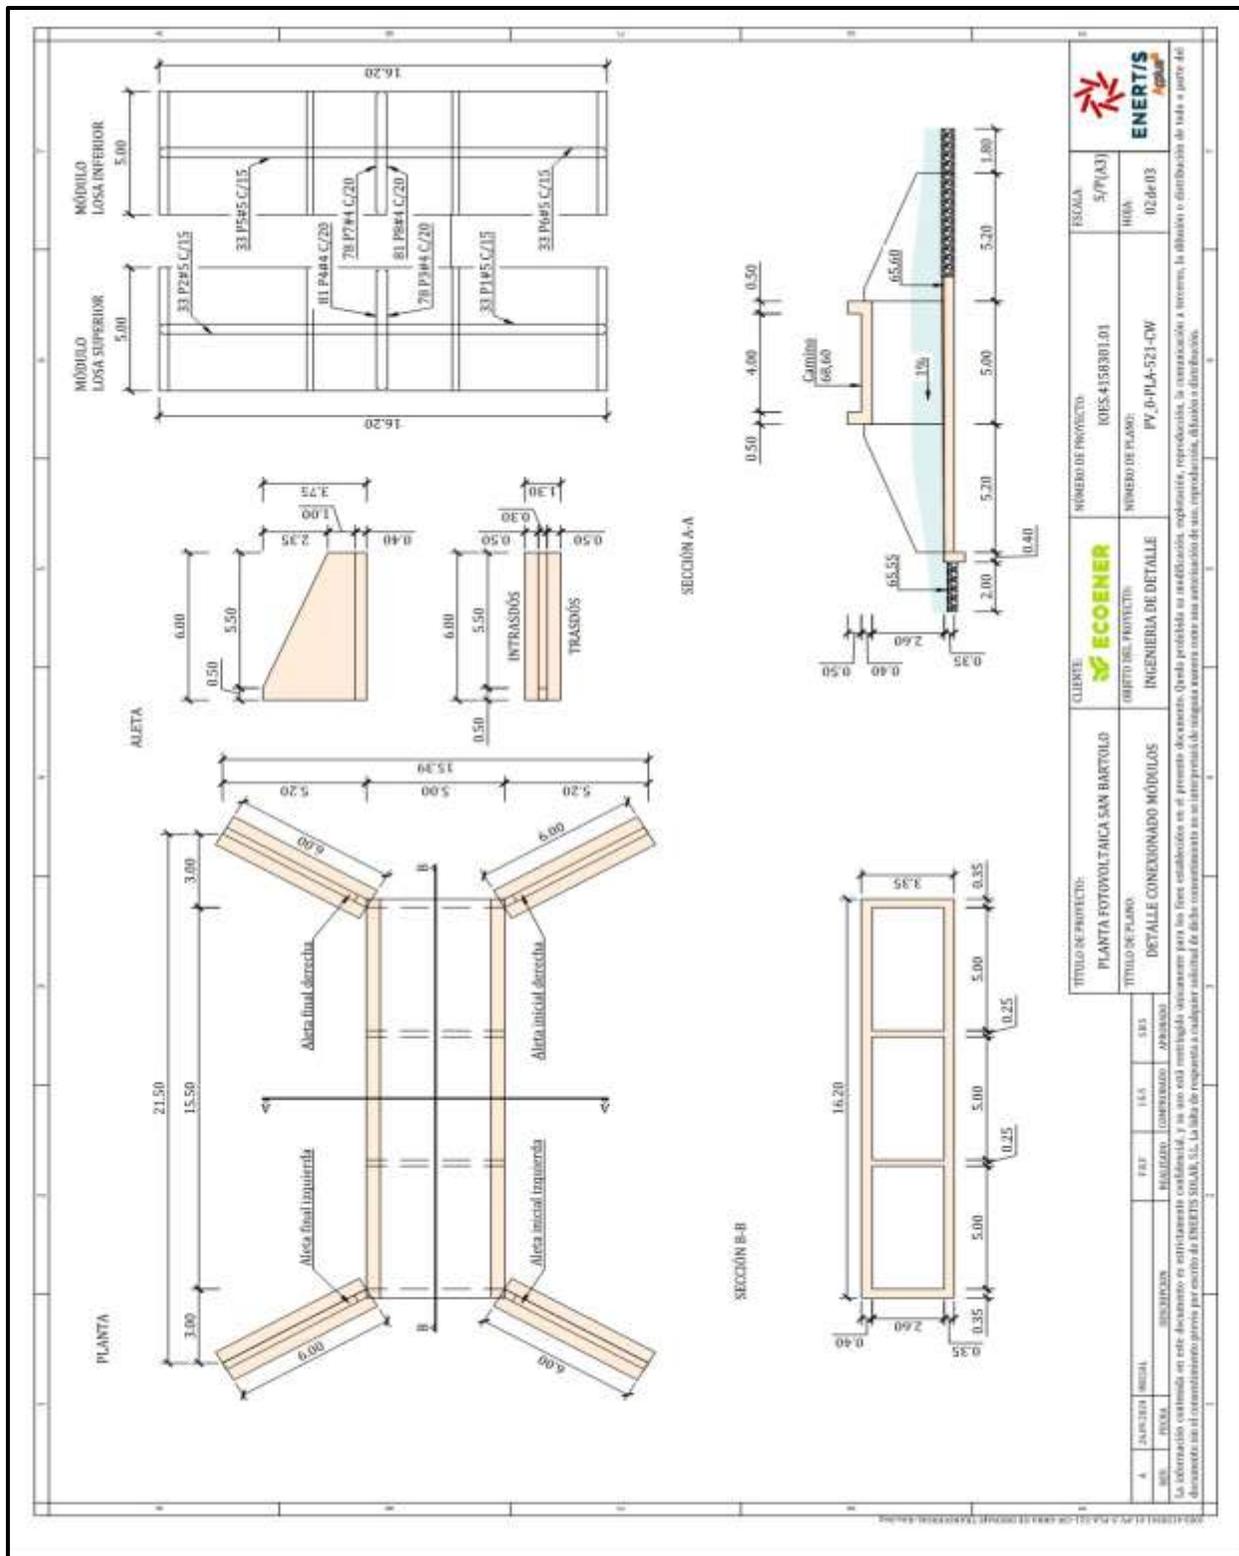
Planta arquitectónica (detalle conecionado de módulos).
